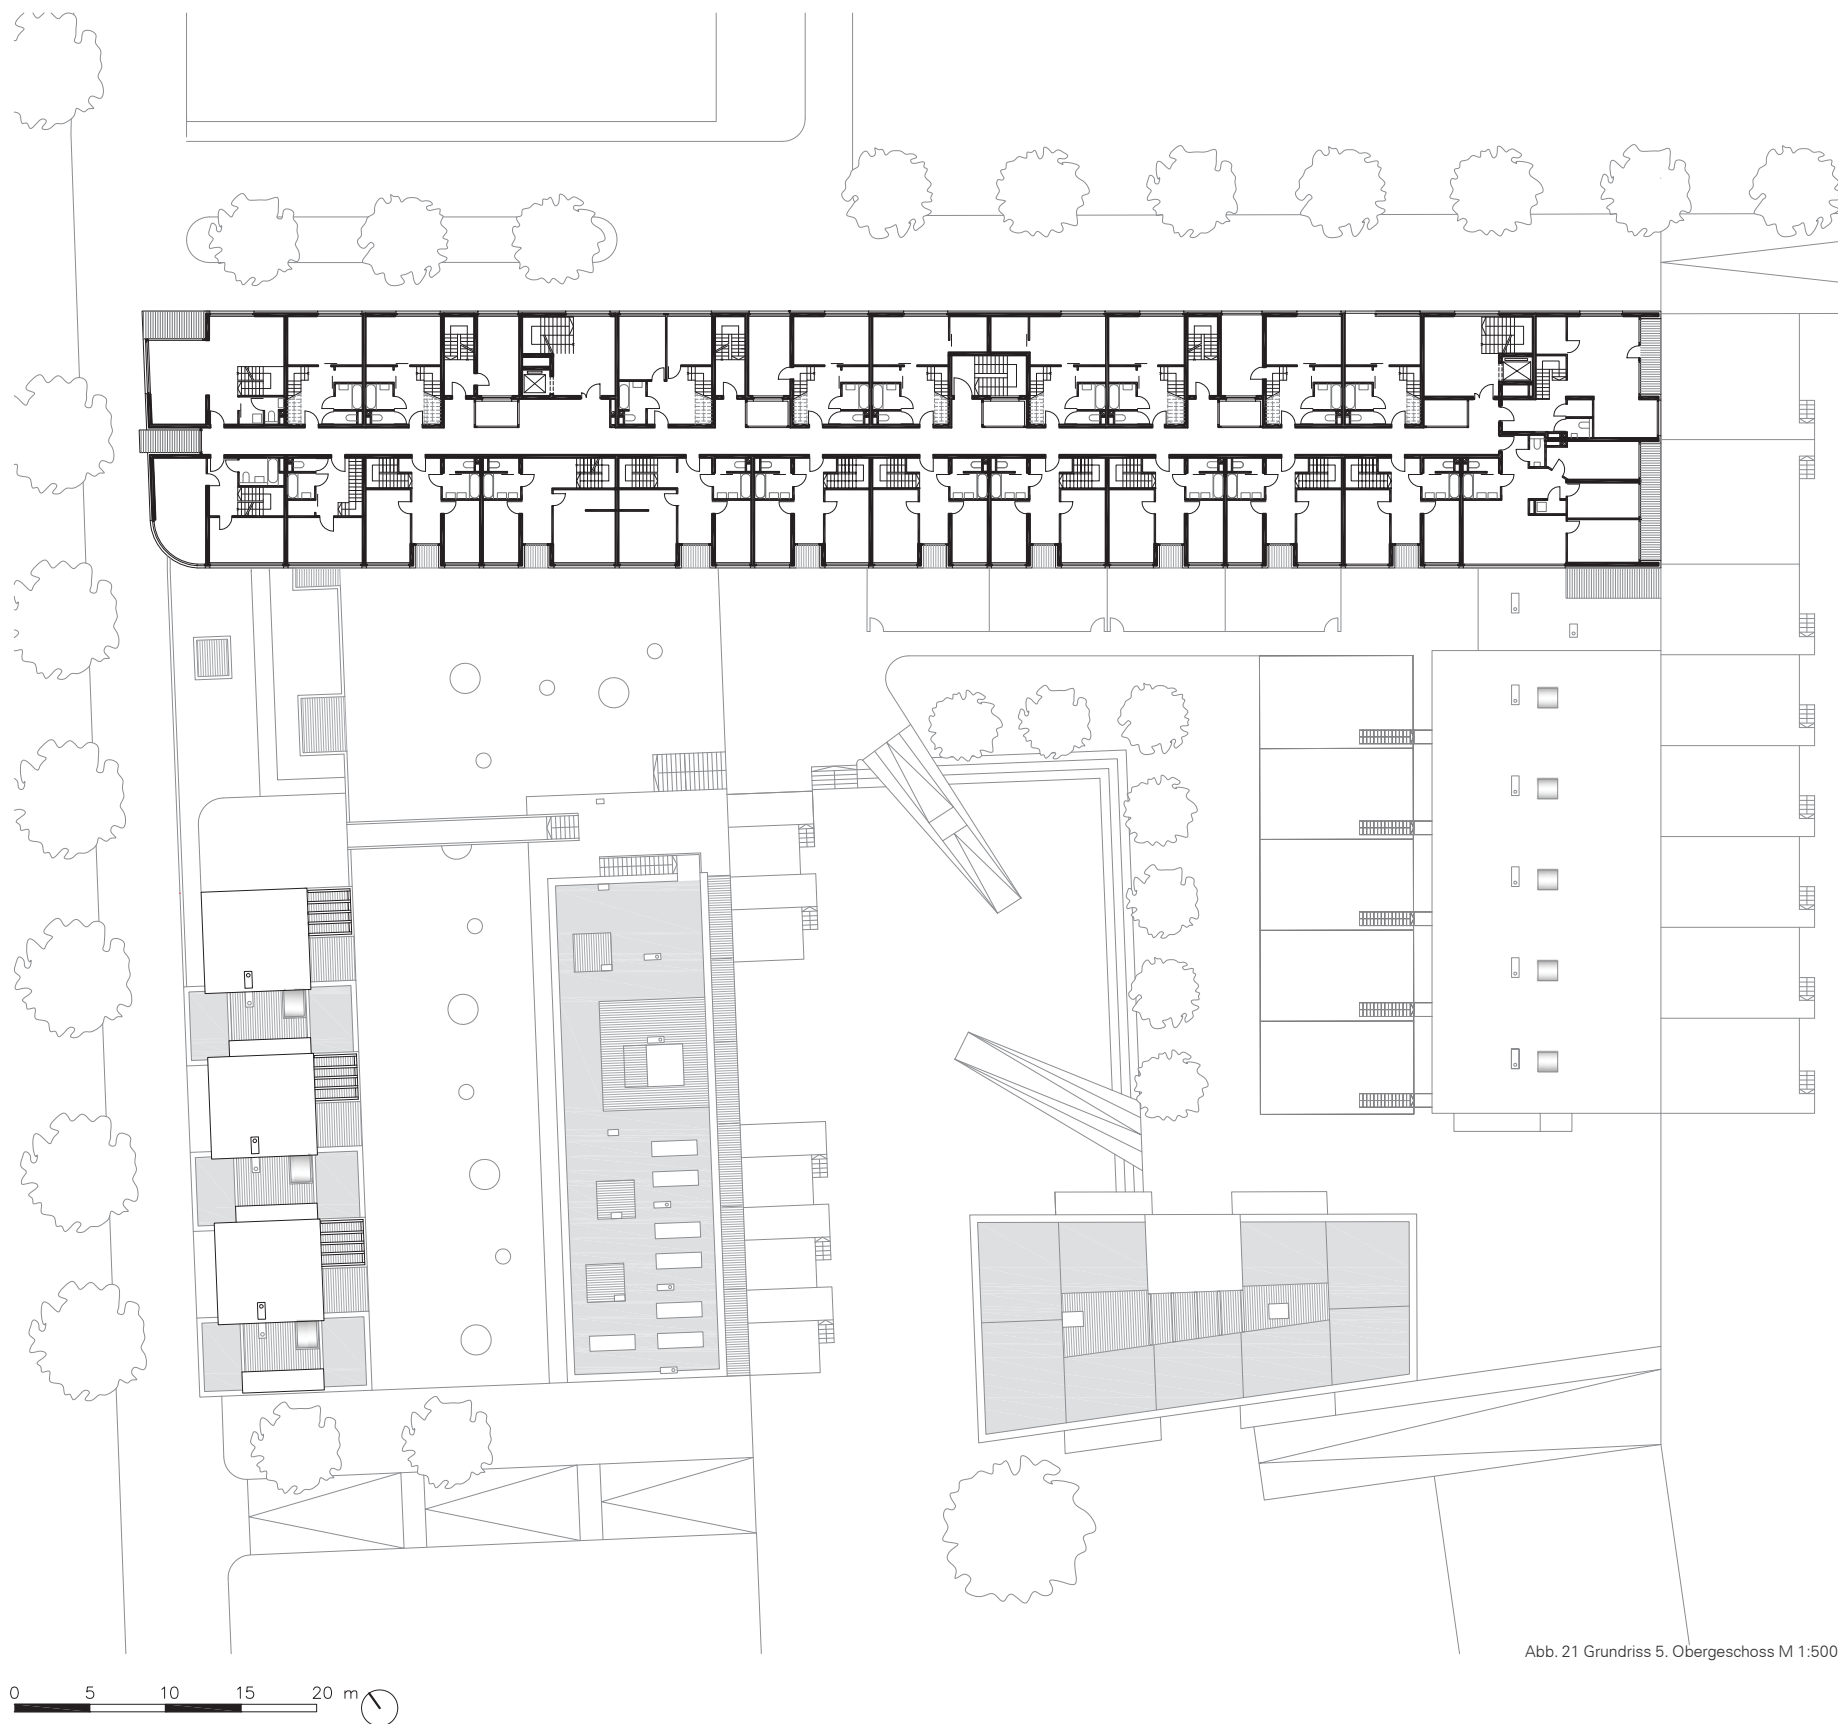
Grundriss 5. Obergeschoss M 1:500
